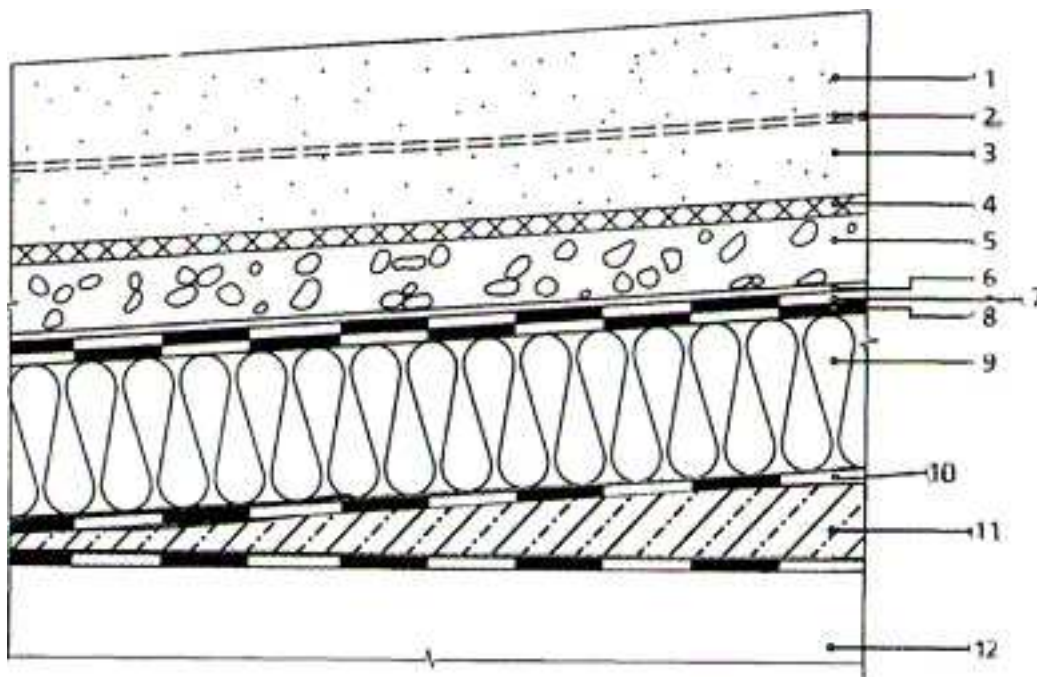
Конструкція даху, що не експлуатується при утворенні нахилу шаром бетону:
